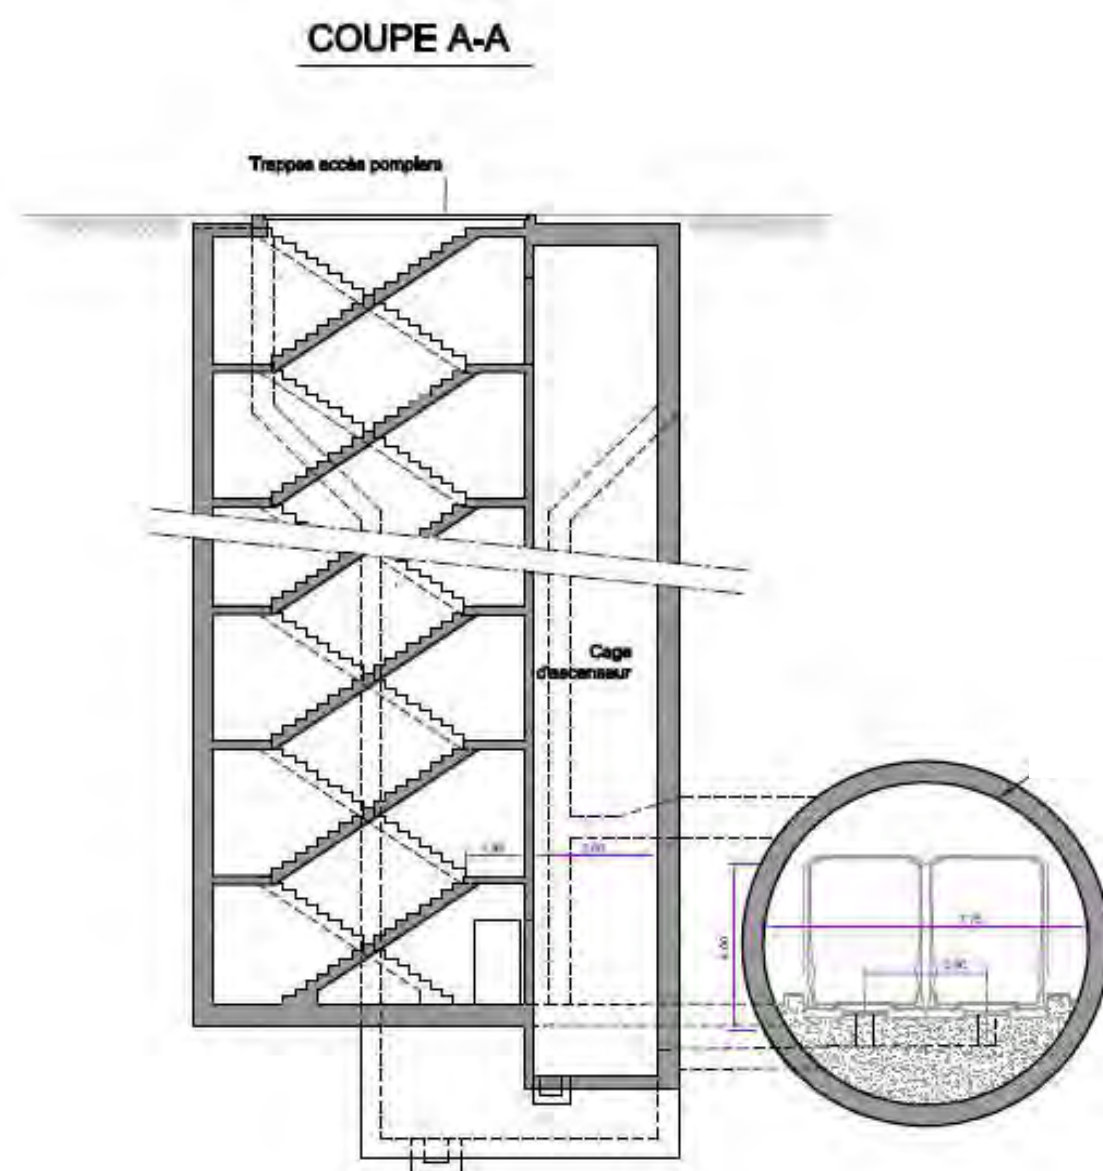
Plan type (h>30m) – Coupe d'ouvrage annexe sur Puits Accès pompier, (Source : Société du Grand Paris)
